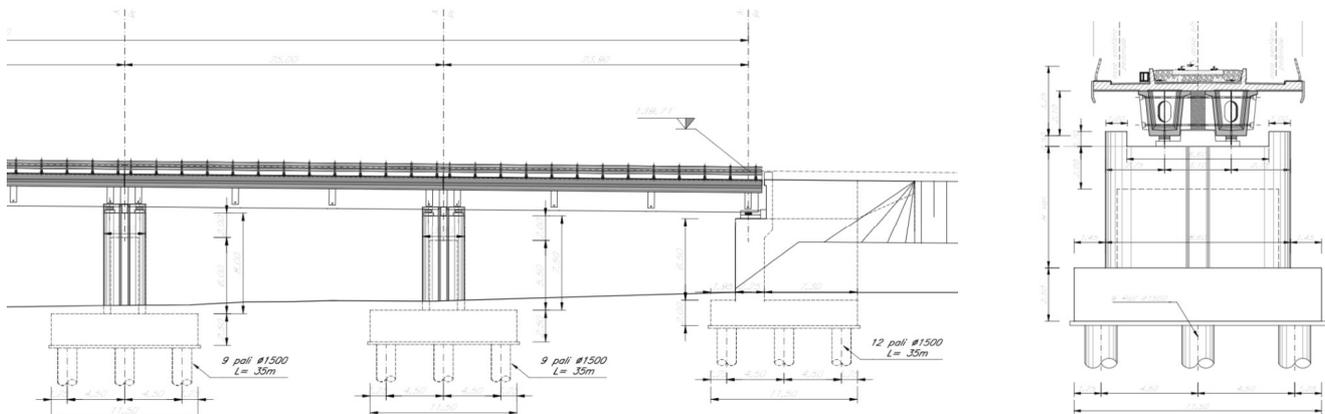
Viadotto VI09 – Profilo longitudinale - Sezione trasversale
